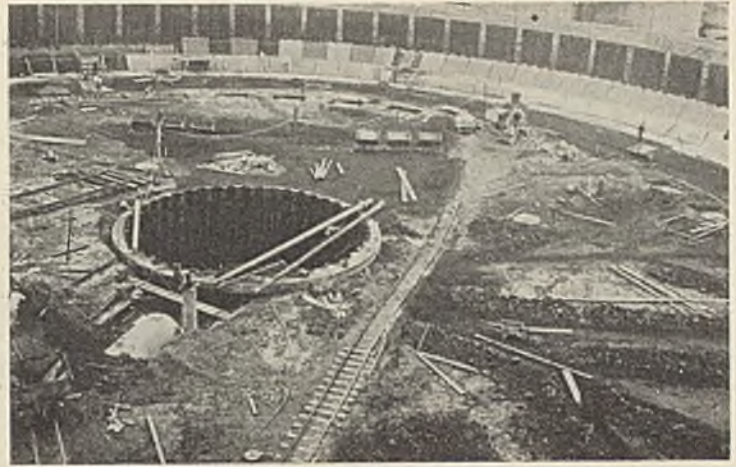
Baugrube für das Mittelbauwerk. Eisenspundwandeneinfassung bis in die untere Tonschicht hinein. Obere Spundwandaussteifung durch einen außen angeordneten Eisenbetonring. Entwässerung des Untergrundes der Beckensohle durch zum Mittelbrunnen geführte Dränagen.
